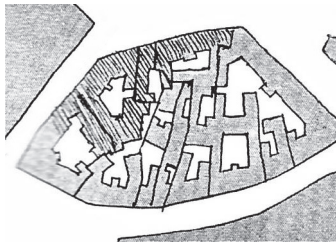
Parigi. Prospetto di un isolato haussmanniano.
